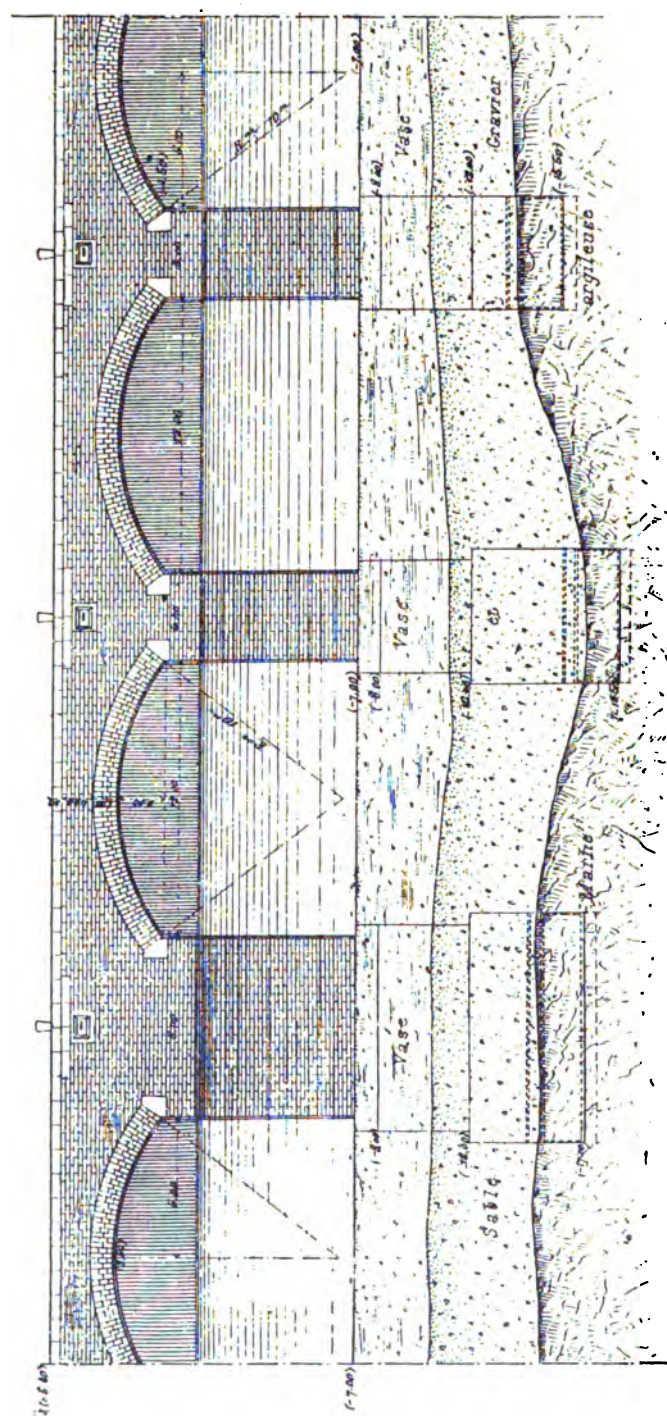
Bordeaux. — Elévation du quai (1er type).
